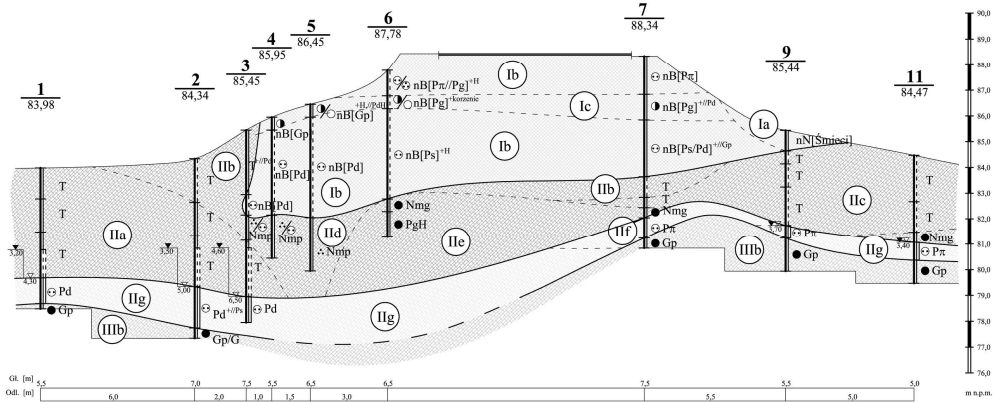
Fragment przekroju geotechnicznego I – I km 83+180
